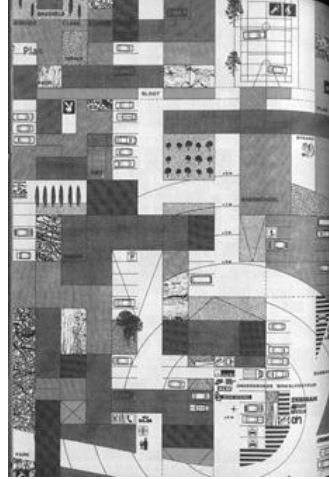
Otopark alanı planı, bu planın birim ölçülerini tutarak uygulanan yapıların bir rastlantısal dağılımı şeması (MVRDV, 1998).
